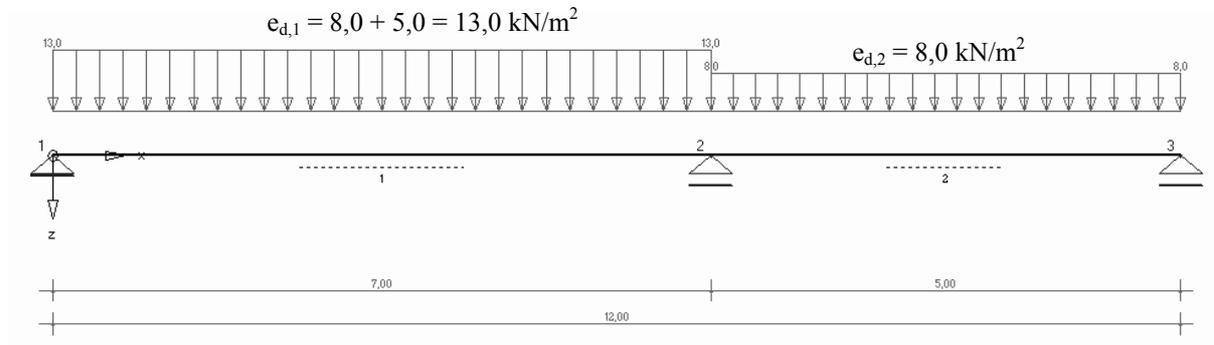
Statisches System, Baustoffe und Abmessungen [11]
